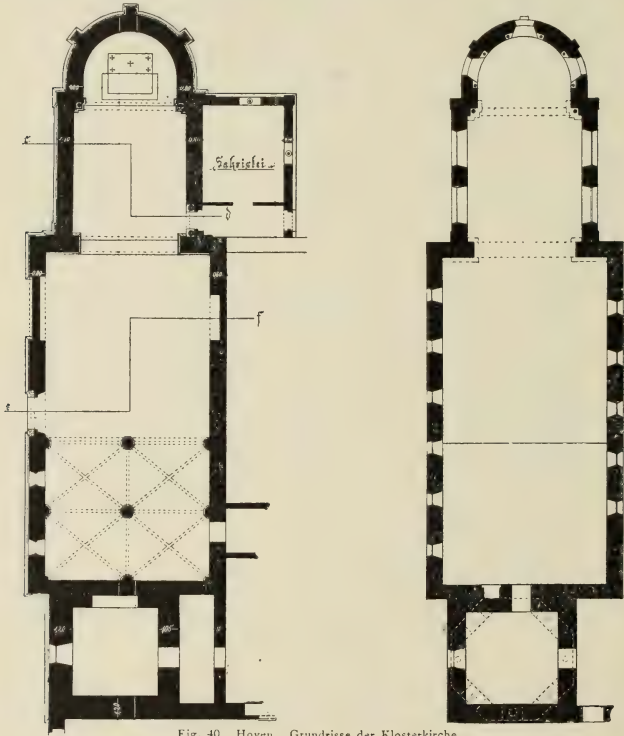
Hoven. Grundrisse der Klosterkirche.
